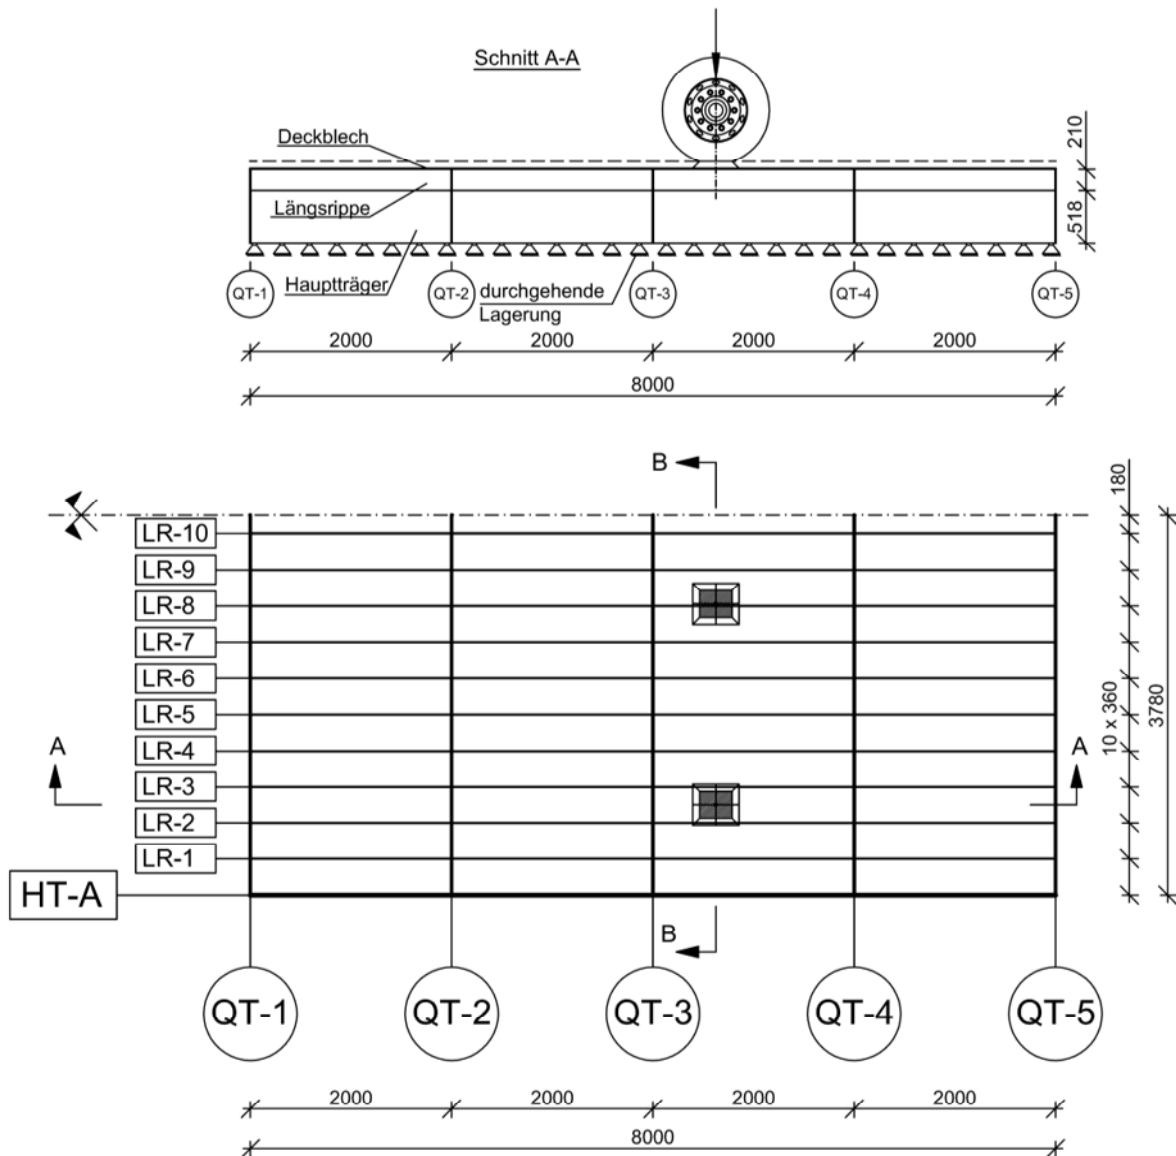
Orthotrope Platte – Grundriss und Längsschnitt
